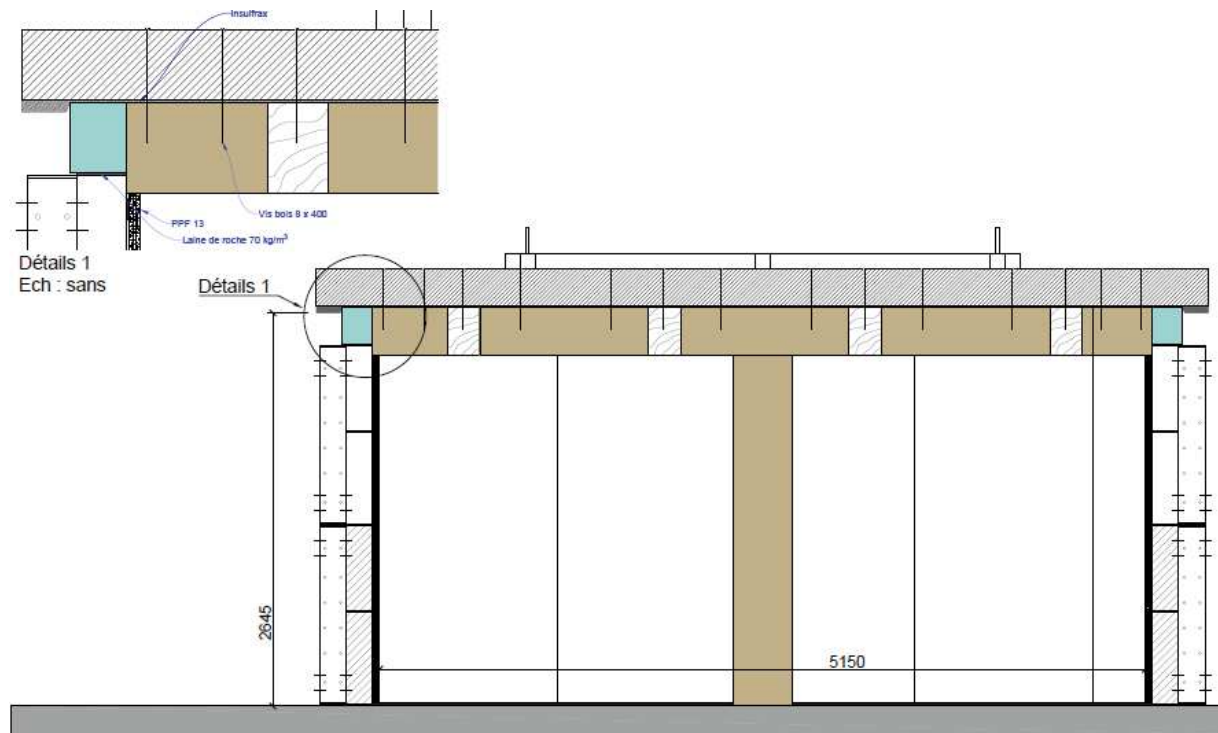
Coupe AA de la cellule d'essai pour l'essai 3 (poteau/poutres LC) avec détail
